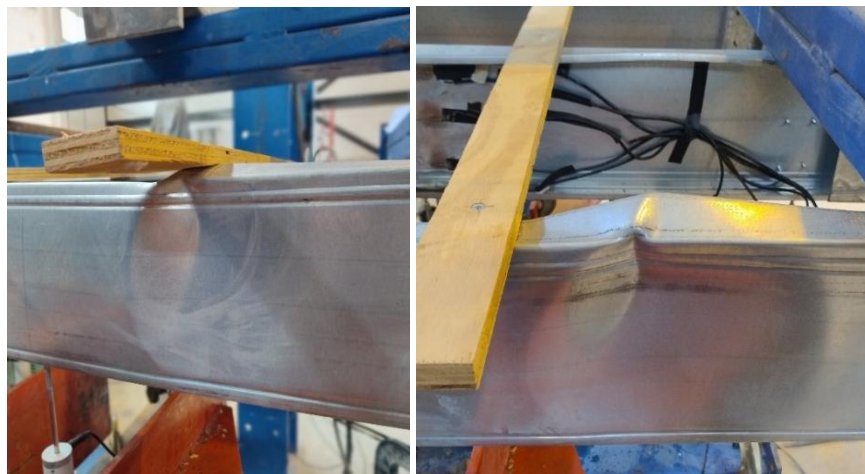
Pontos de falha dos corpos de prova A e B da laje L-1
